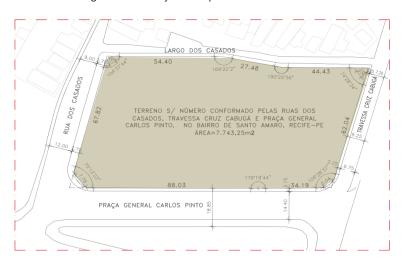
Planta de Situação do Empreendimento. fonte: Projeto Arquitetônico
